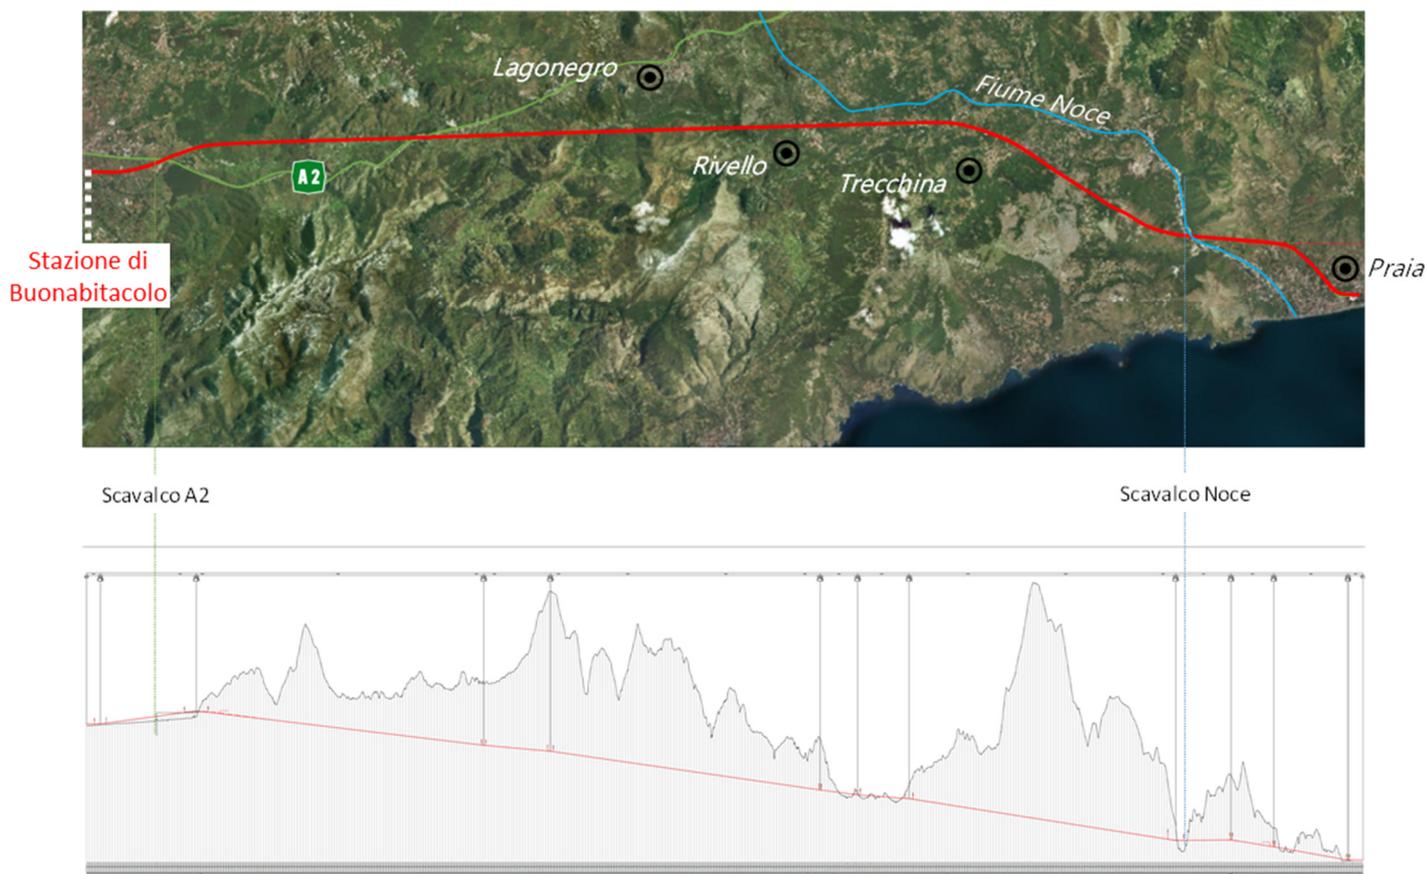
Profilo piano-altimetrico dell'alternativa di tracciato A
